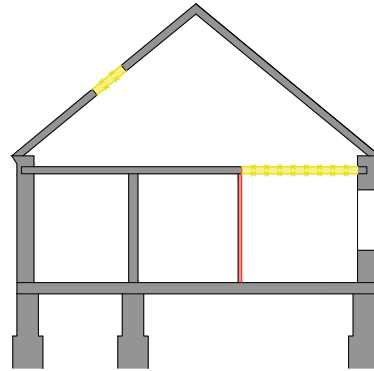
Rot-Gelb Plan Schnitt Singlewohnen M 1:200
